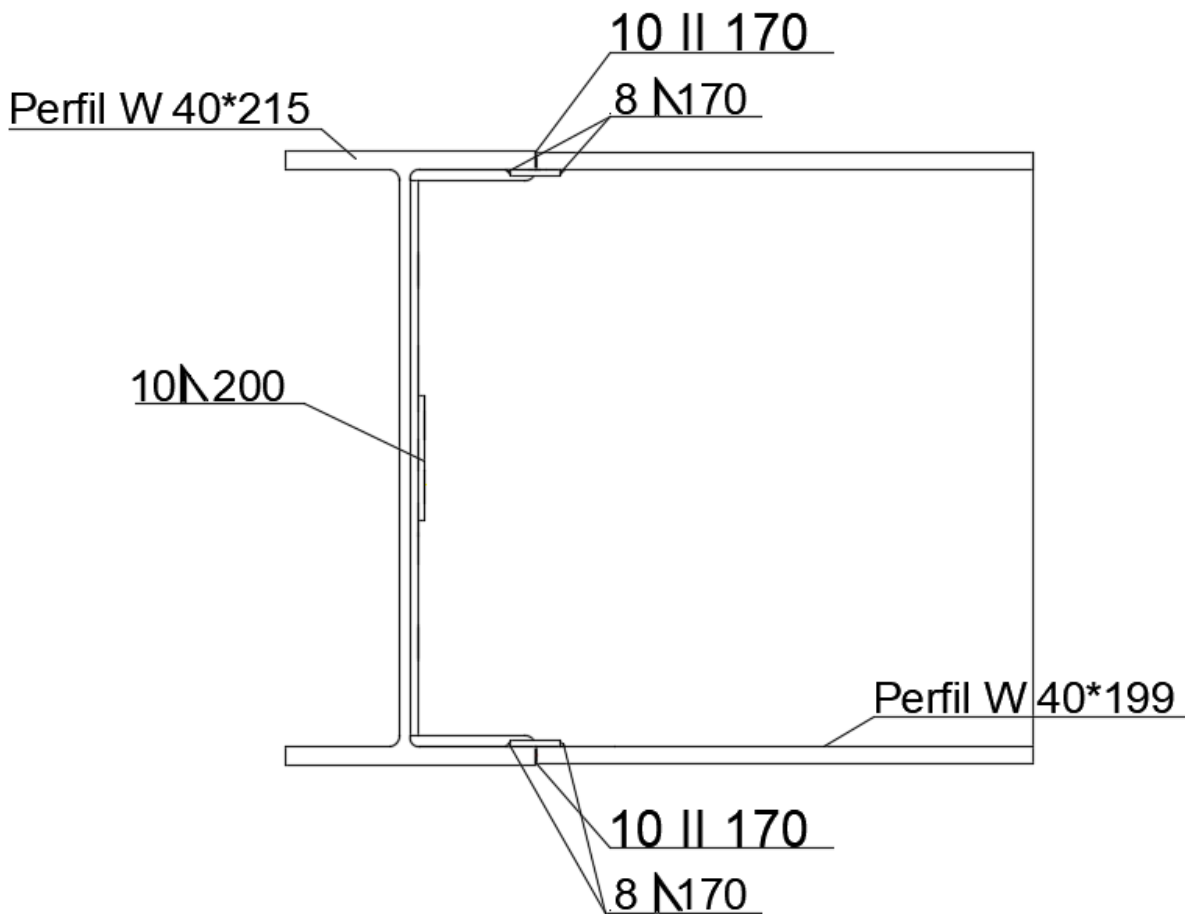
Detalle unión soldada entre vigas longitudinales y transversal.
